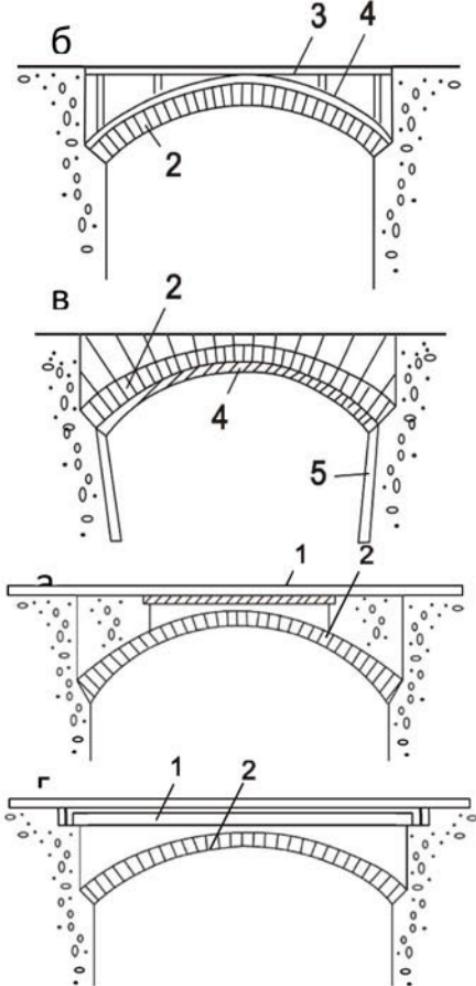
Схемы усиления сводов каменных и бетонных мостов: а – частичной или полной разгрузкой сводов; б – расположением дополнительного свода сверху существующего; в – то же, снизу существующего; г – путем устройства плитного пролетного строения; 1 – железобетонная плита; 2 – существующий свод; 3 – облегченное надсводное строение; 4 – свод усиления; 5 – уширение опоры
